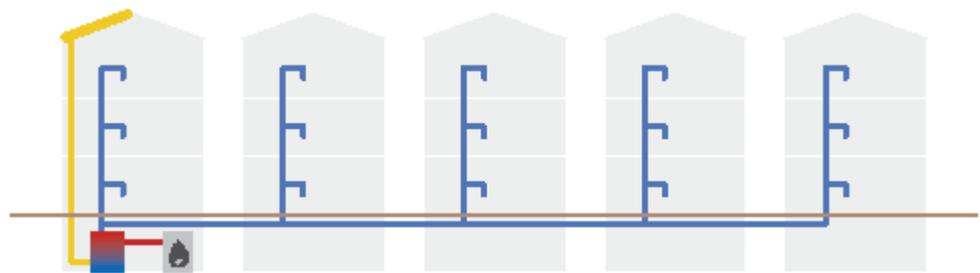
Prinzipschema Gebäudesituation: Warmwasser und Heizwärme aus Zentrale
